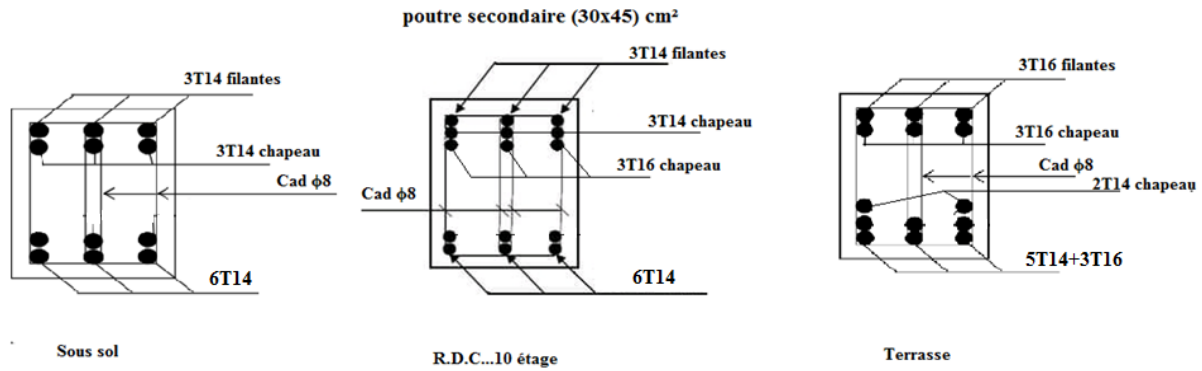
dessin de ferrailage des sections des poutres secondaire.
